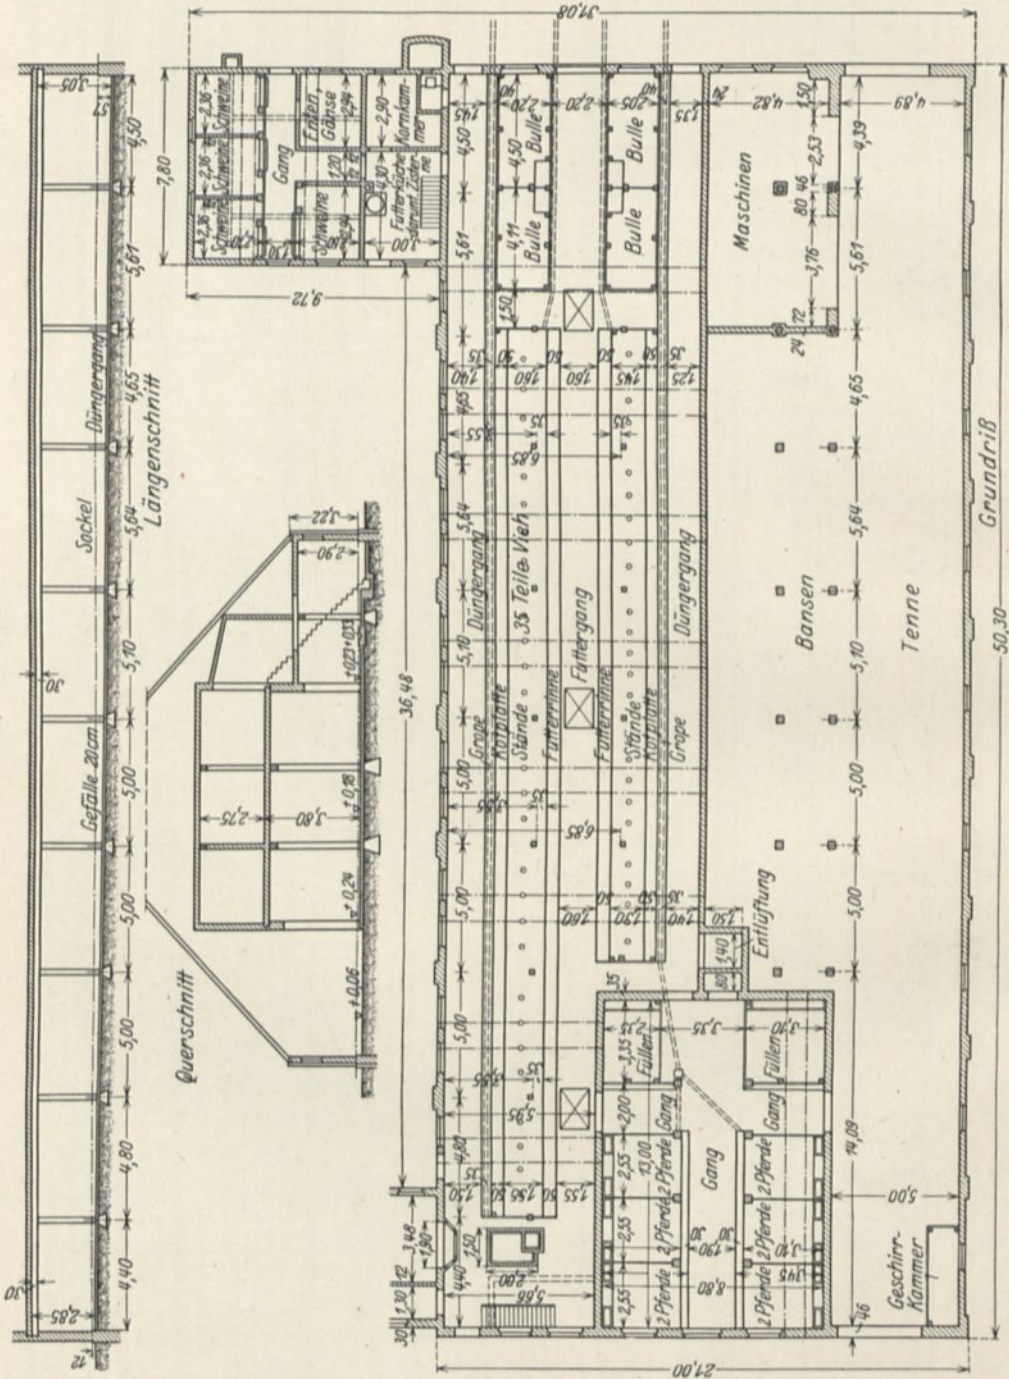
Stallgebäude mit Scheune in Connhäusen (Oldenburg). Allgemeine Anordnung: Grundriß, Längen- und Querschnitt. (Ausführung: H. Möller, Wilhelmshaven.)
